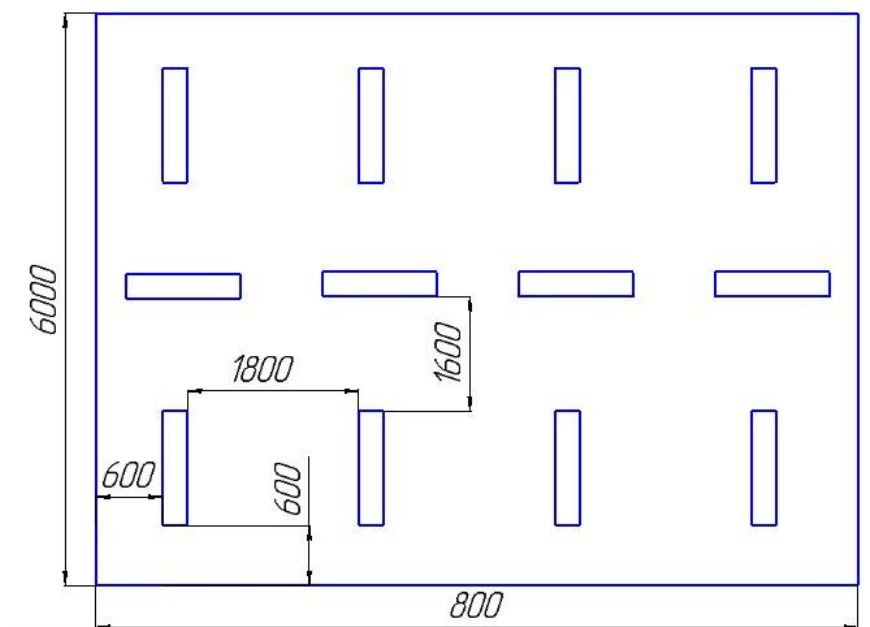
План помещения и размещения светильников с люминесцентными лампами
